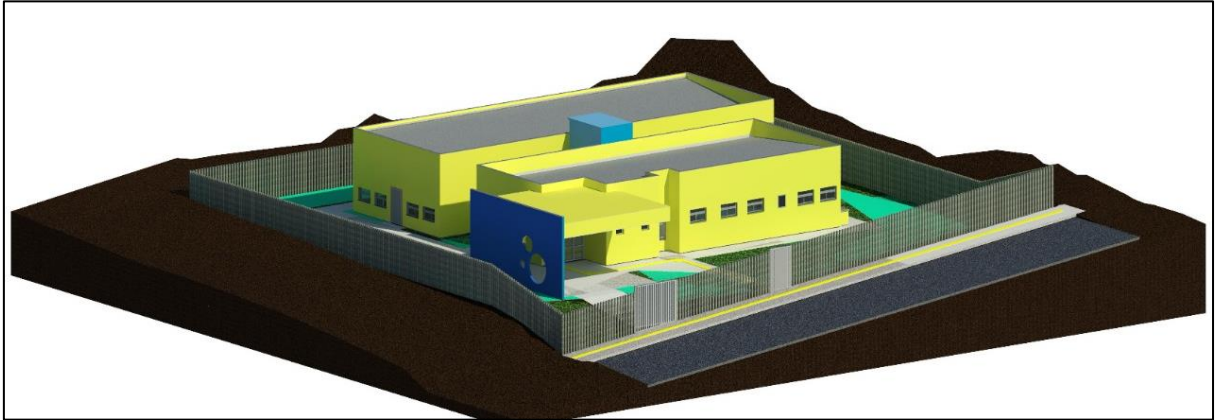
Modelagem arquitetônica: Elevações B e C do projeto original
